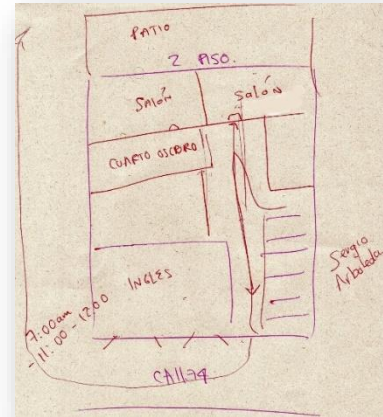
, plano segunda planta instalación de la 74, estudiante SJ
